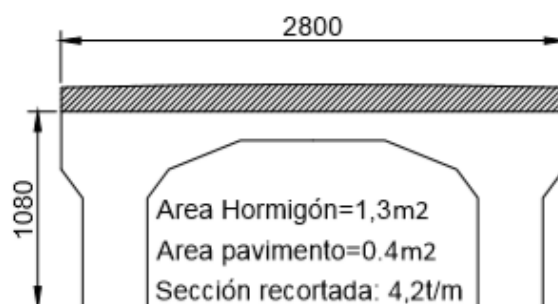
Sección transversal primera propuesta AutoCAD.
